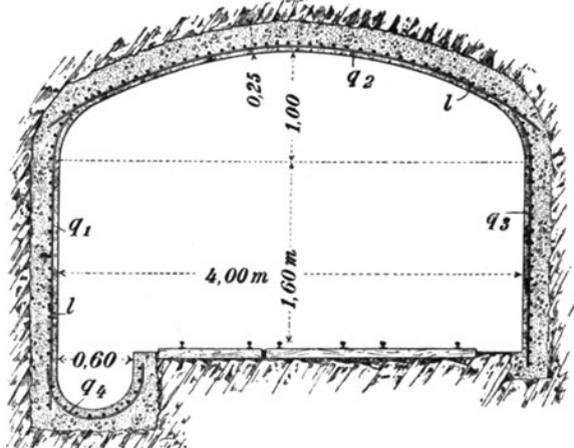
Eisenbetonausbau in einem Hauptquerschlag.
